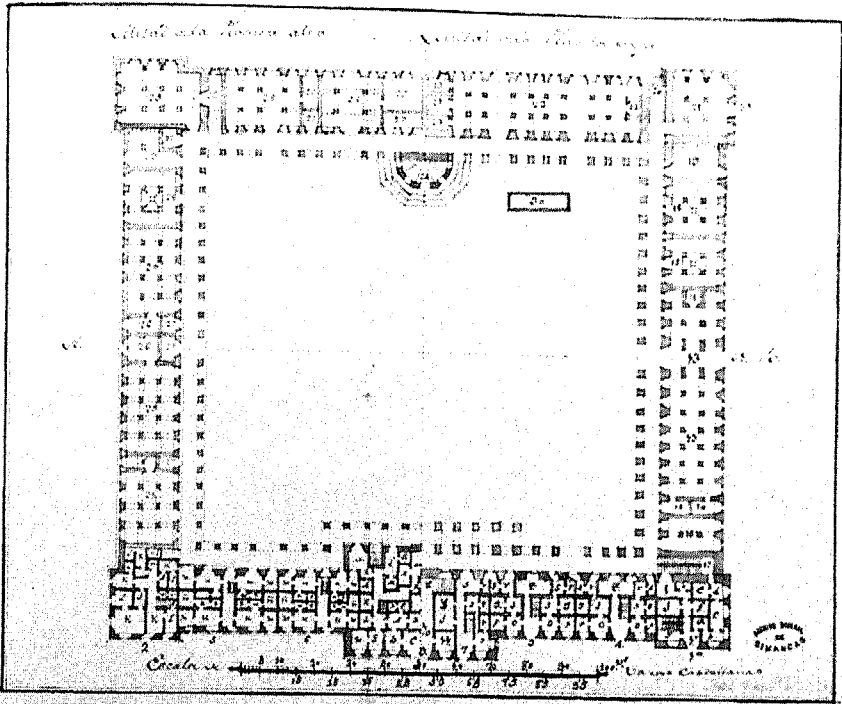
Primera propuesta de Cuartel de Caballería realizada por Caraza con mitad de la planta alta y mitad de la planta baja. [A.G.S. M.P.D. XLVII-17]
